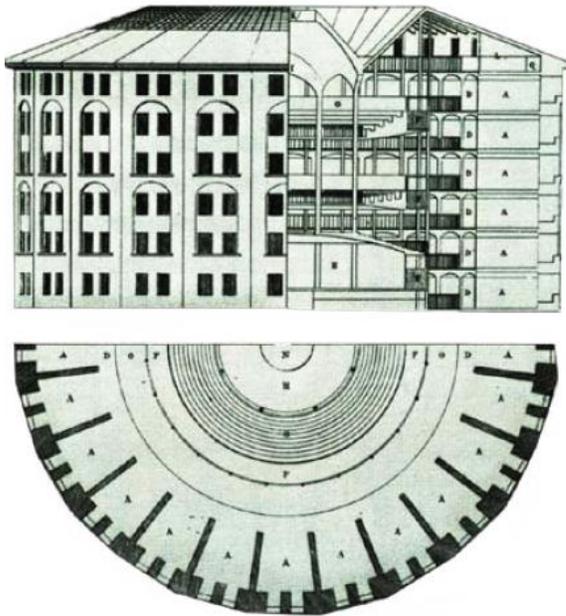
Panopticon de Bentham, alzado, sección y planta dibujado por Willey Reveley (ca. 1971)
